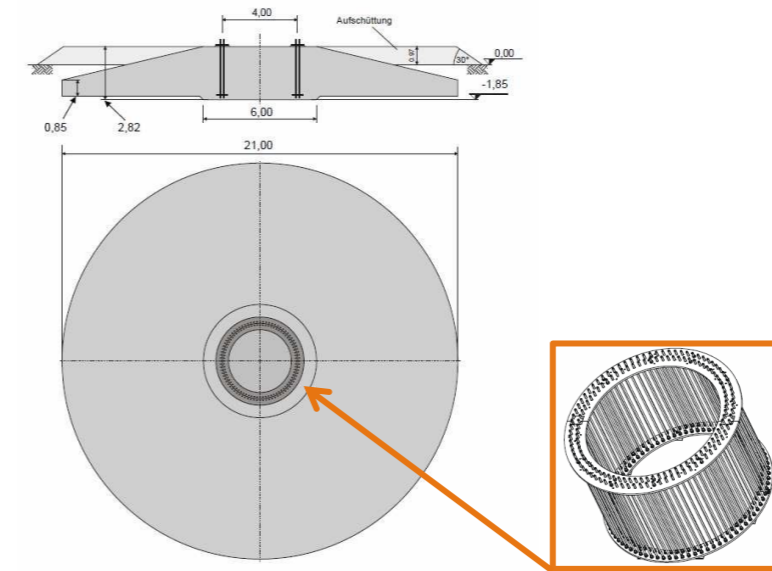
Schéma indicatif d'une fondation type et de sa cage d'ancrage
